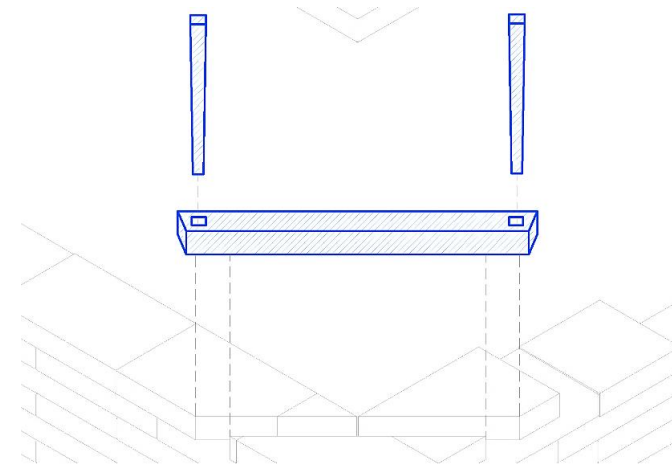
Detalle técnico de dispositivo DE, variante perdida en muro. Fuente: Elaboración propia.
